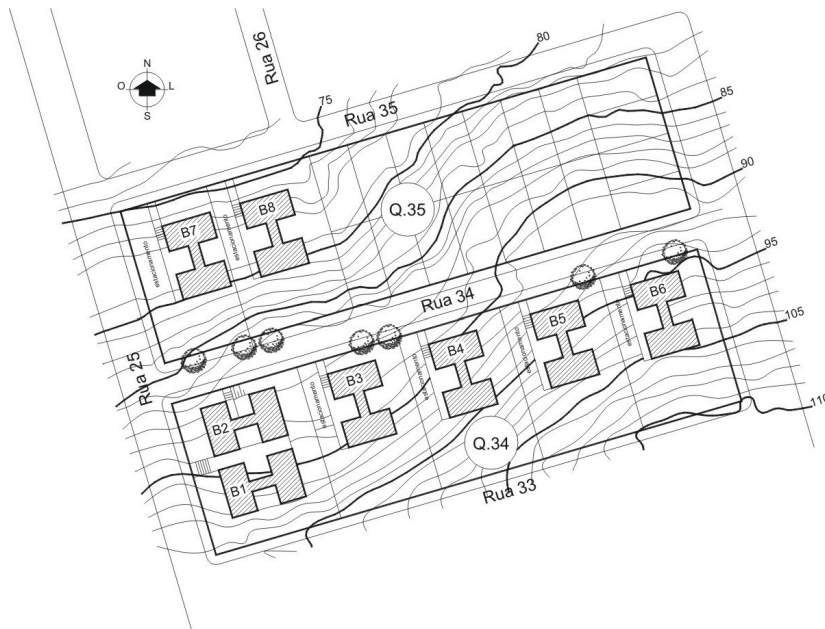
Planta de implantação. Fonte: HERMSDORFF e SOUZA, 2006.
